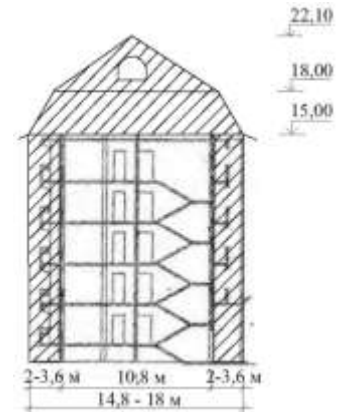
Схематичный разрез жилого дома устройством мансардного этажа
